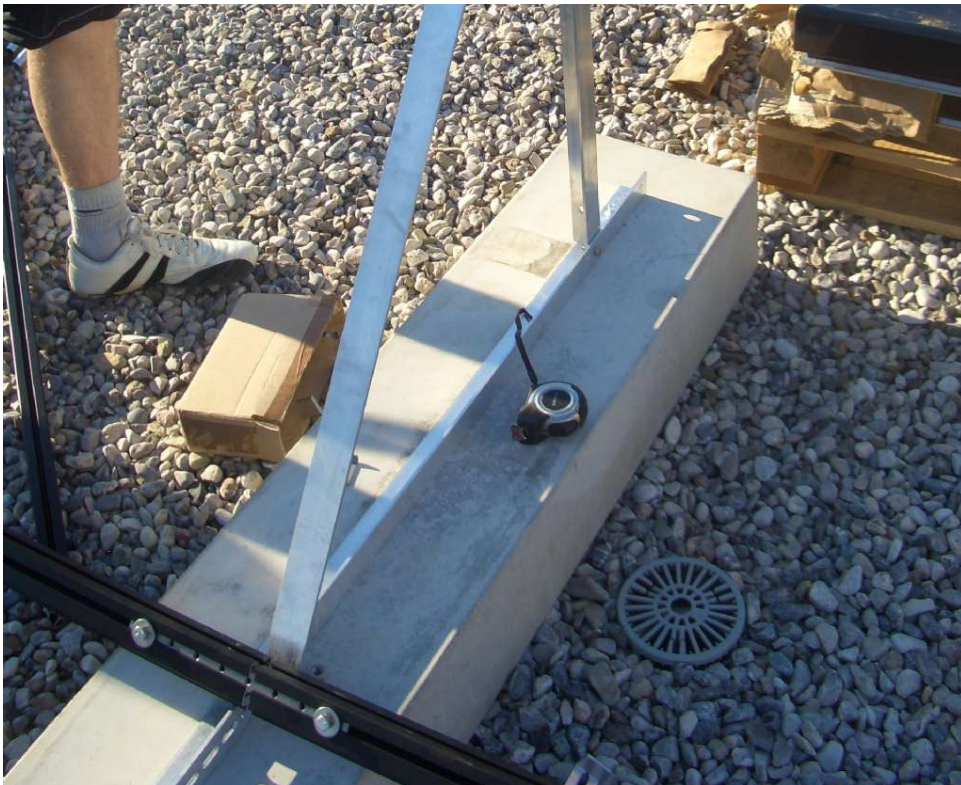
Betonballast für Flachdach-Montage (www.energiesparhaus.at/05.07.2014)
